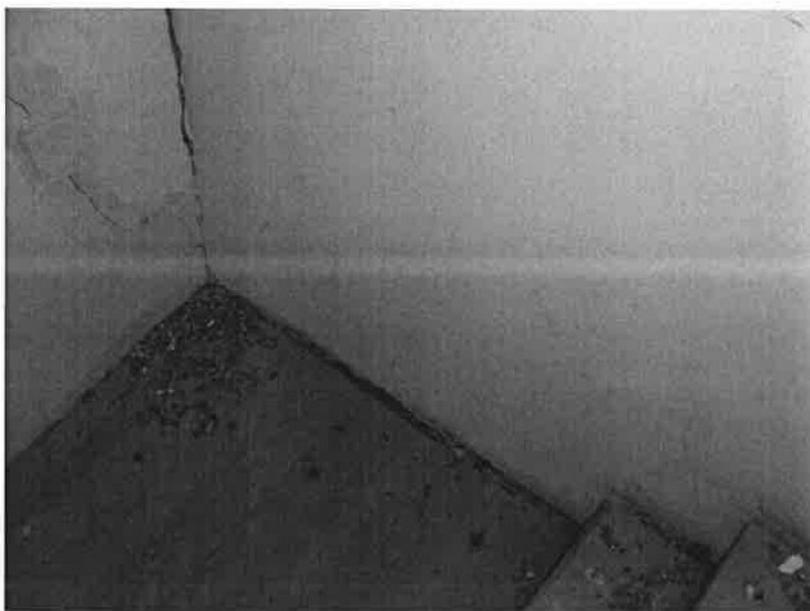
( Descolamento pavimento de parede, acesso sótão )
